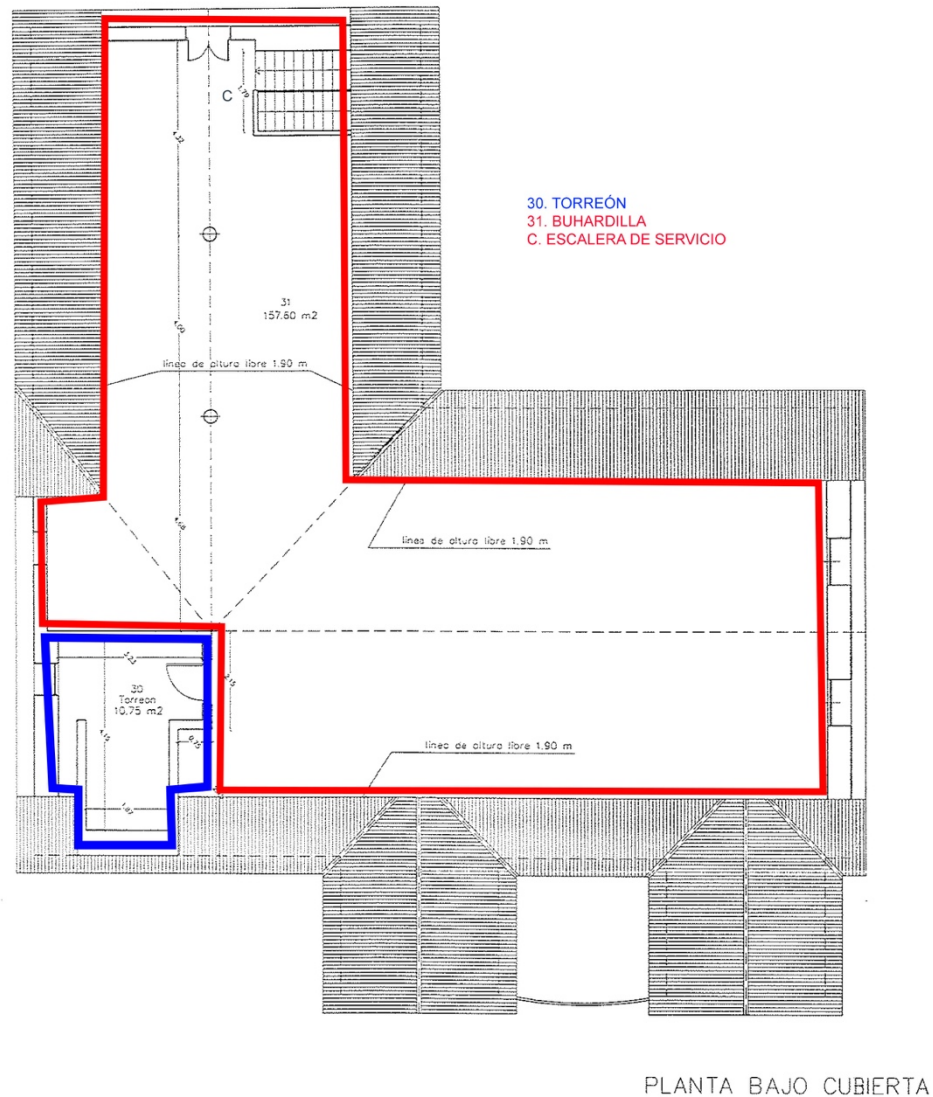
Planta de la buhardilla. Fuente: Elaboración propia en base a plano de AENA.
